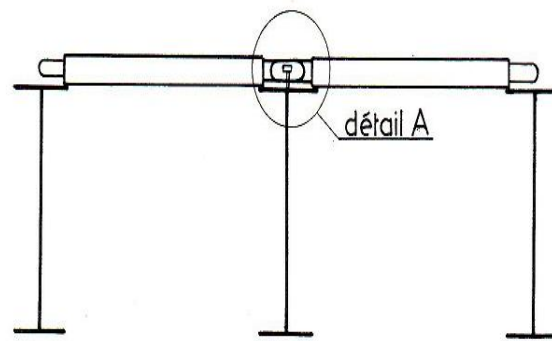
Coupe transversale détaillant la position du goujon
